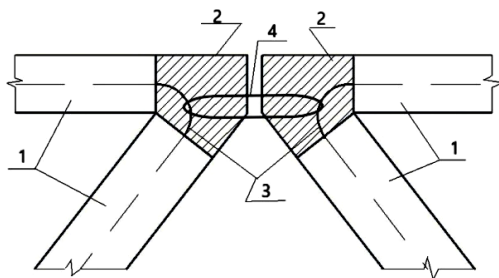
Вариант объединения балок в перекрытии с помощью шпонок: 1 – элементы балок; 2 – монолитные участки балок; 3 – сетки балок, укладываемые перед бетонированием основных пластин; 4 – хомут, объединяющий сетки смежных балок.
